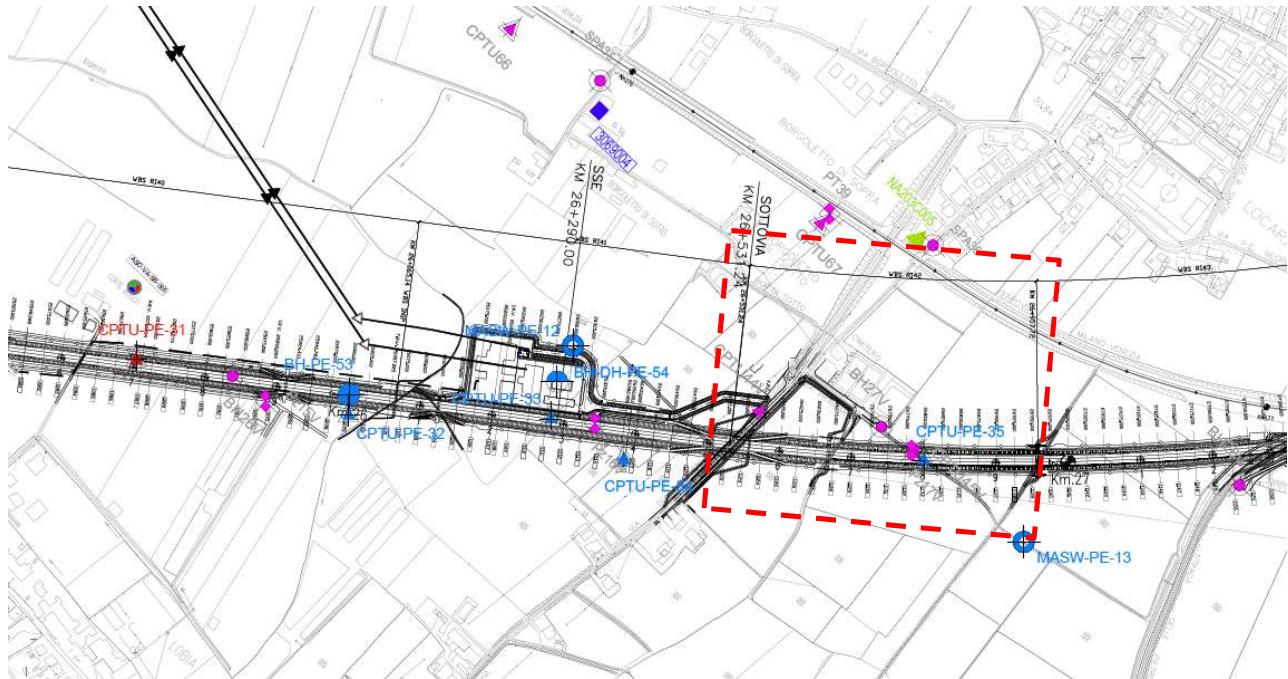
Planimetria Rilevato R42, estratto dalla Planimetria Generale (Doc. Rif.[6])
